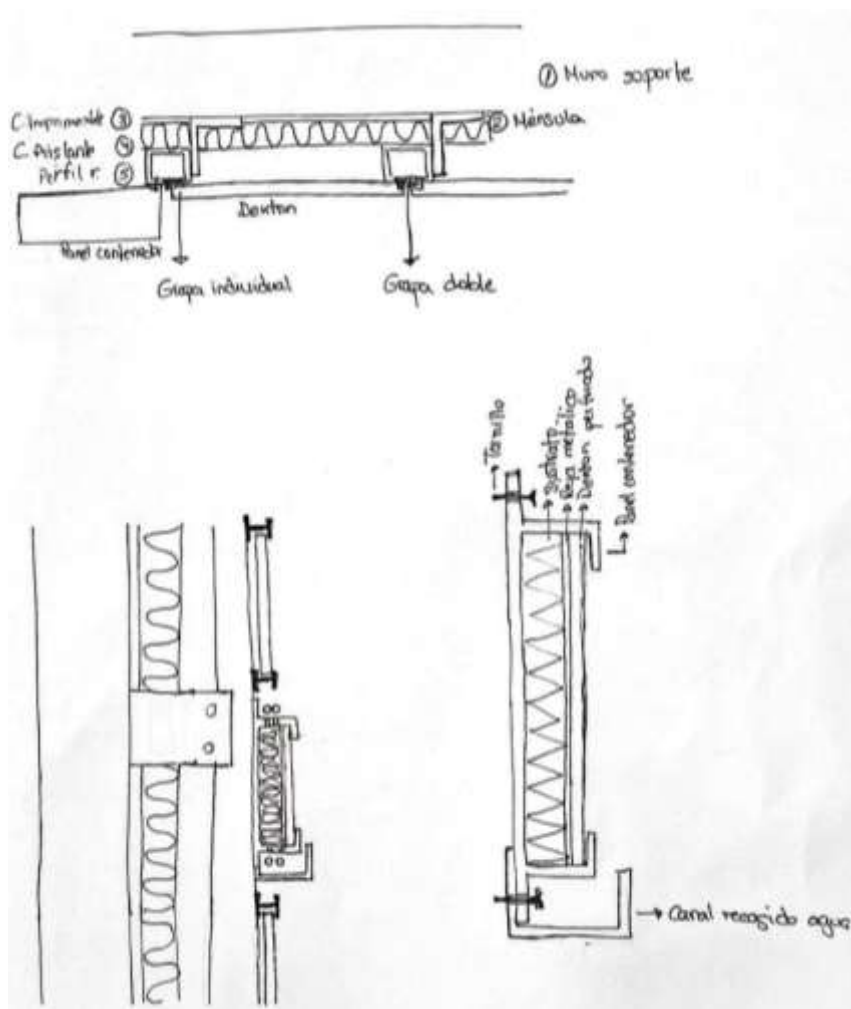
Sección de la fachada vegetal elegida. Fuente: Elaboración propia
